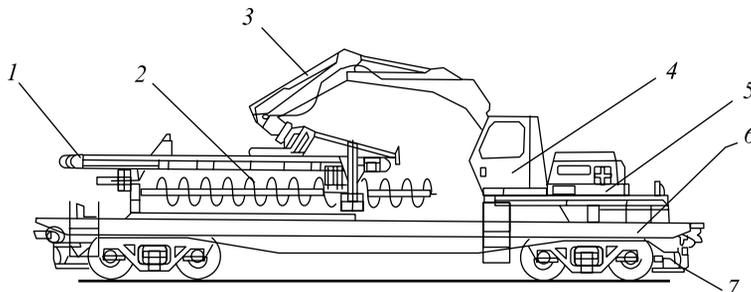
Машина МРКС-1А: 1 — захват; 2 — буровое оборудование; 3 — манипулятор; 4 — кабина; 5 — силовая установка; 6 — базовая платформа; 7 — привод хода
